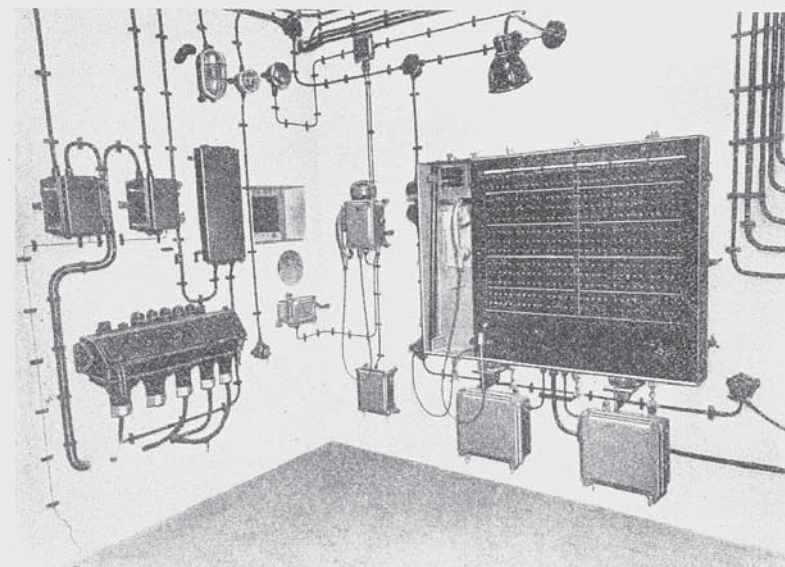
Festungsvermittlung zu 30 Leitungen, betriebsfertig eingebaut
